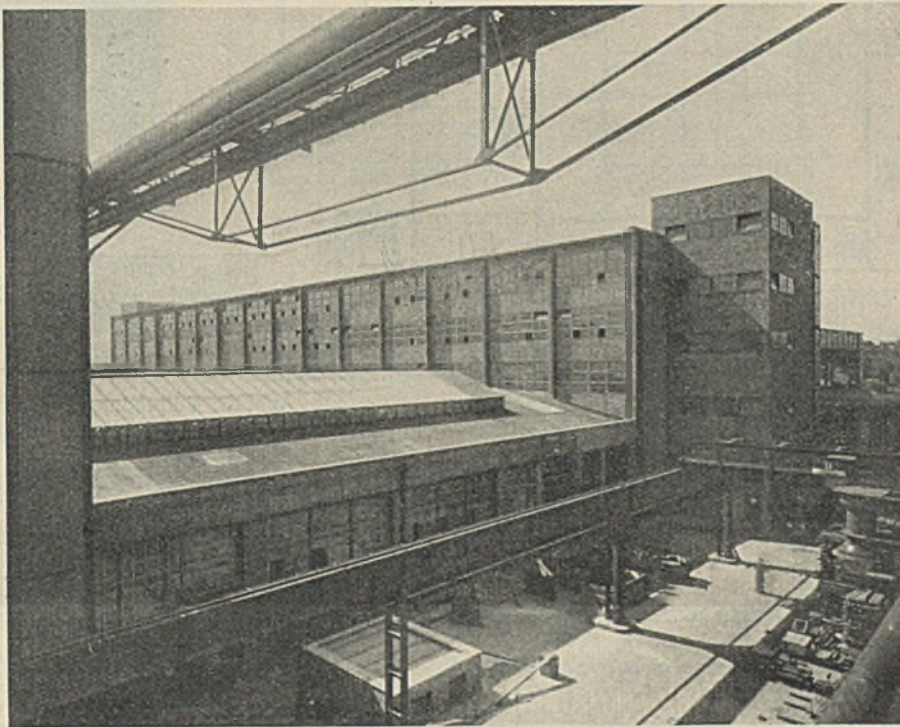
Ansicht der Fernmeldekabelfabrik.
